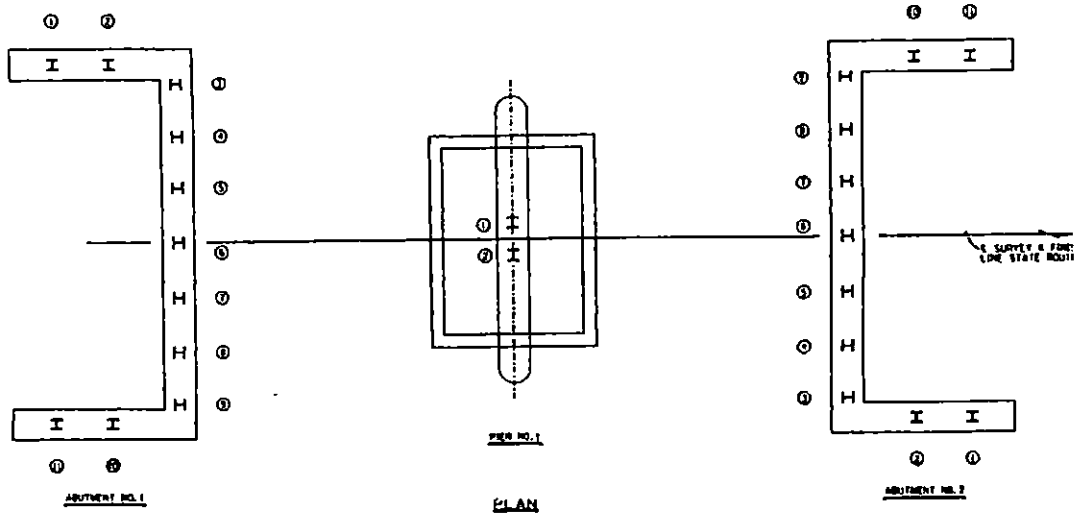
VISTA EN PLANTA DE LA FUNDACION.
